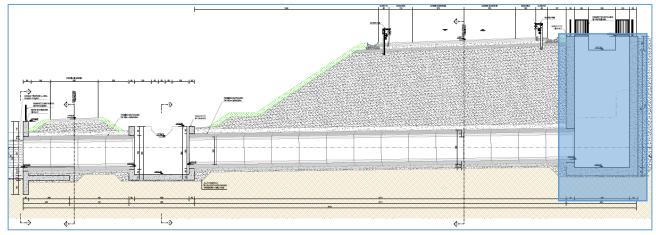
SEZIONE LONGITUDINALE TOMBINO TM18DDX
